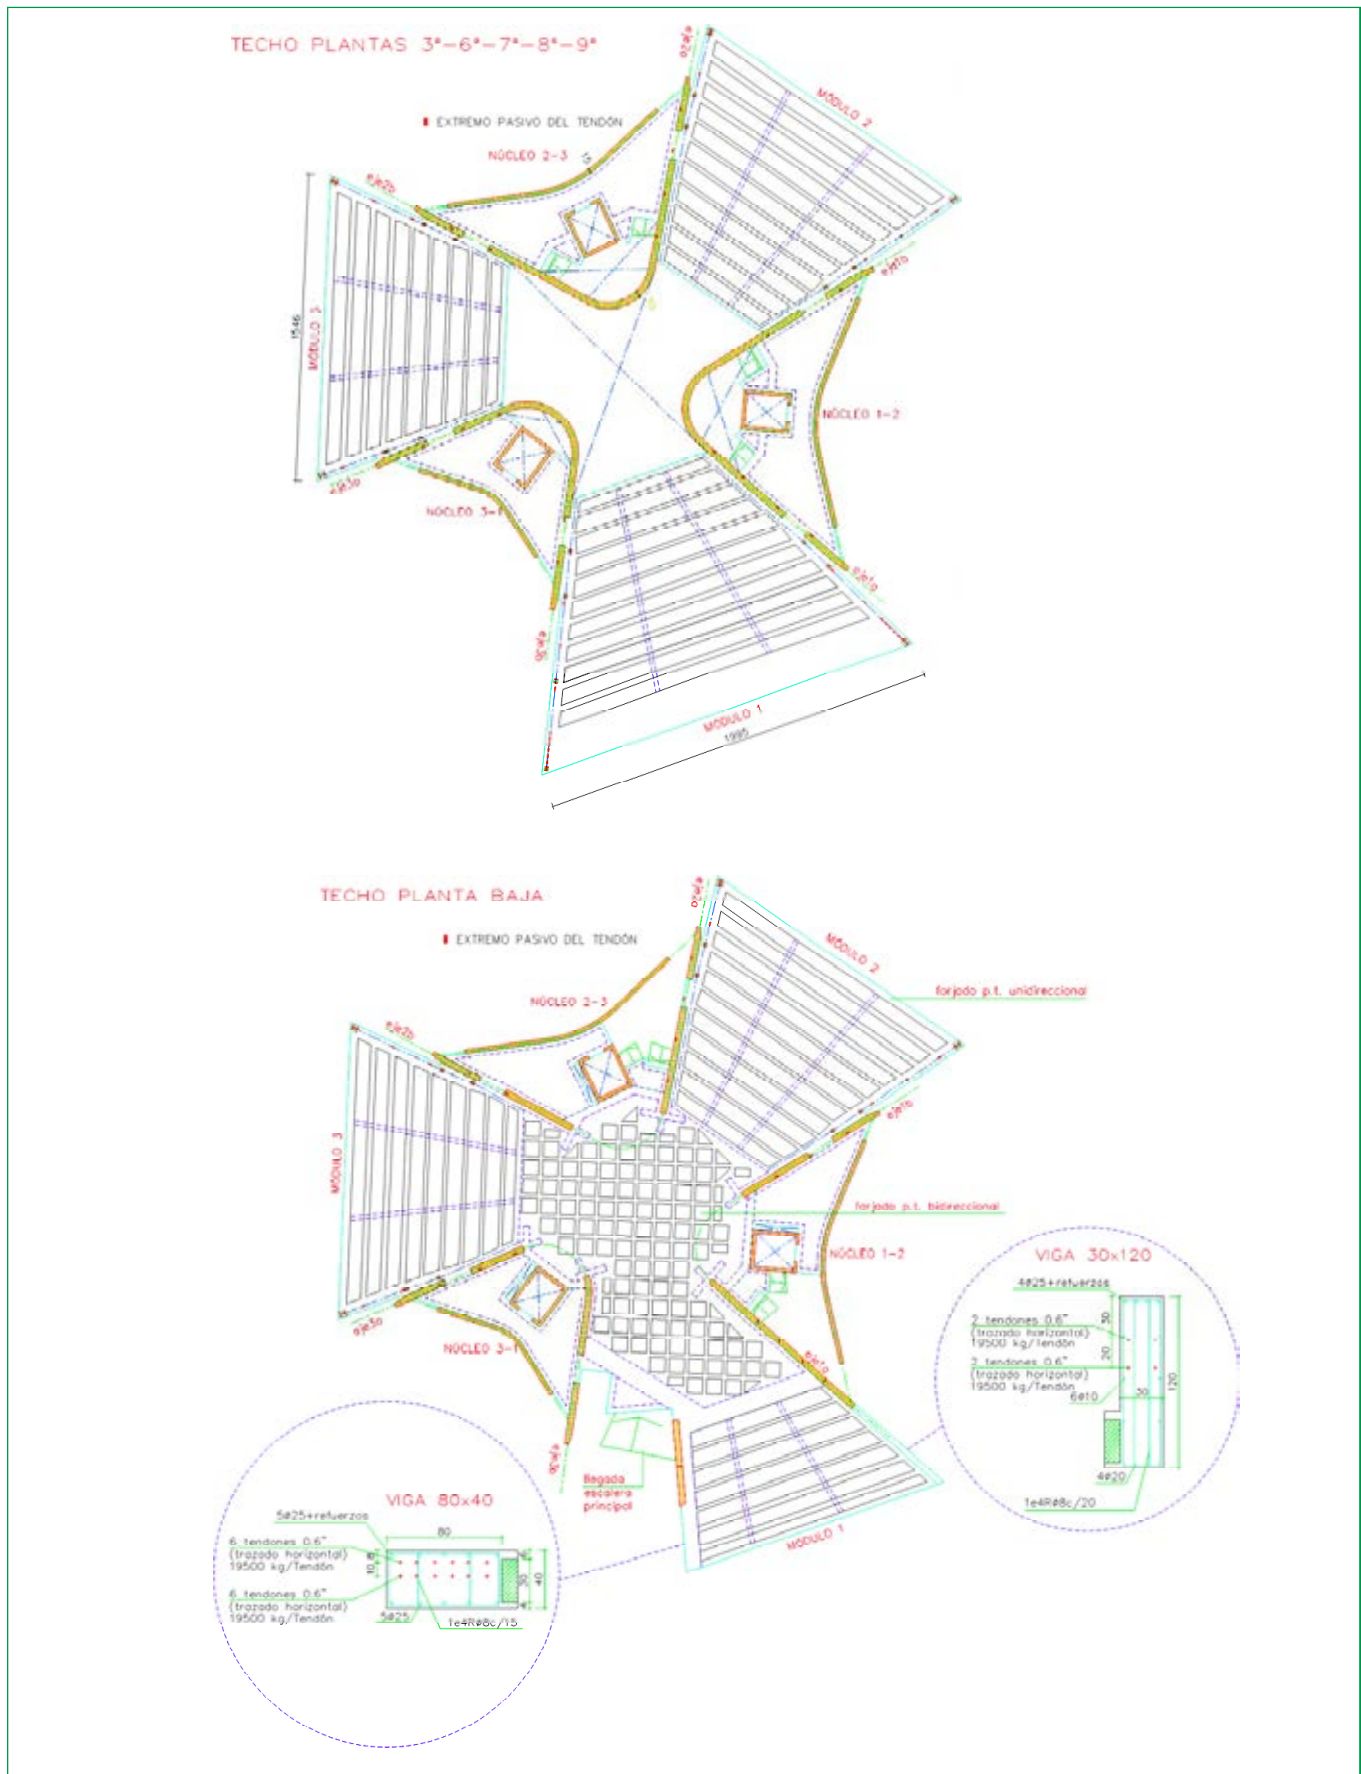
Planos estructurales para dos plantas tipo de la torre CUBE.
